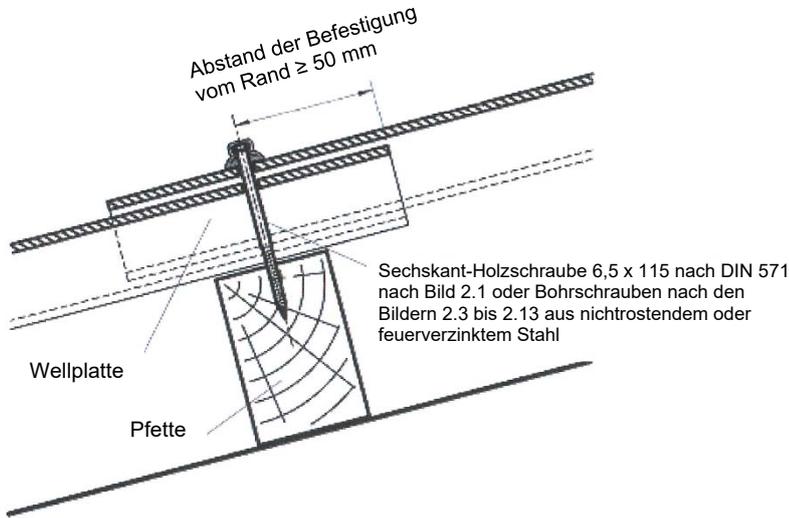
Anordnung der Befestigung auf Holz-Unterkonstruktionen mit Holzschrauben
